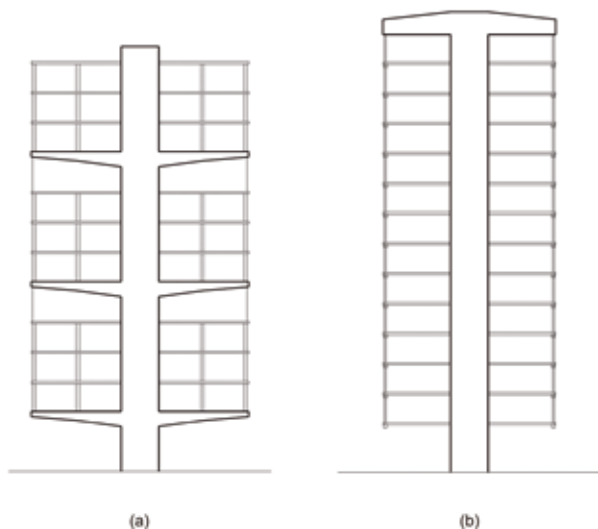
Edificio con núcleo central y (a) plantas apoyadas o (b) plantas colgadas
